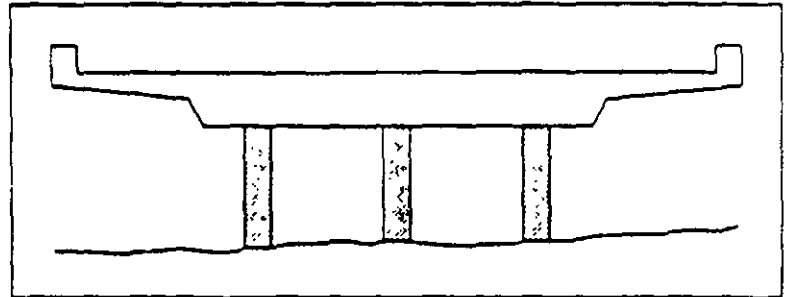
Pila, tipo 21, 2 o más columnas sin cabezal
